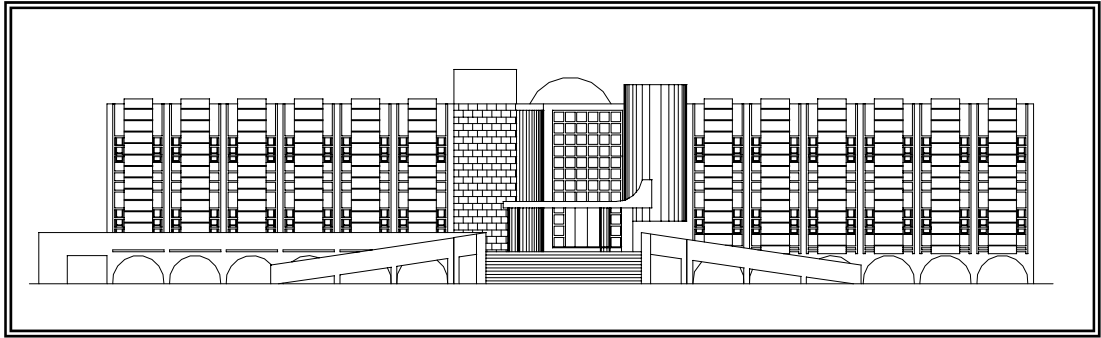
Bâtiment du "cabinet" de la wilaya, la façade principale
